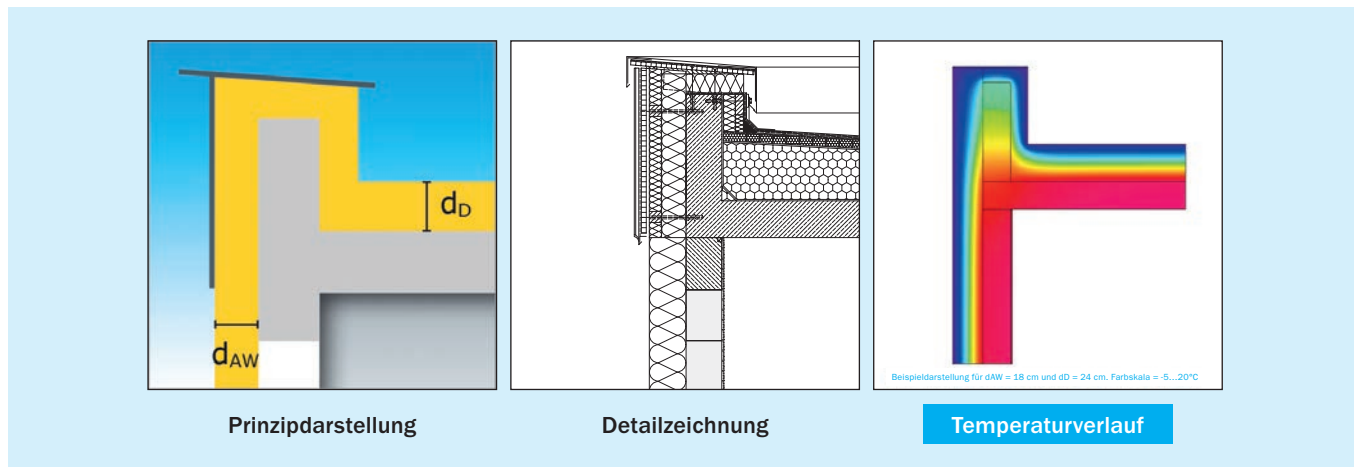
Wärmebrückendetail Traufe/Attika: Beim Übergang zum Dach kann sowohl beim Schrägdach ein Übergang ohne relevante Verringerung der Dämmdicke erreicht werden als auch bei Ausführung einer Attika beim Flachdach, bei der negative Wärmebrücken Standard sein sollten
